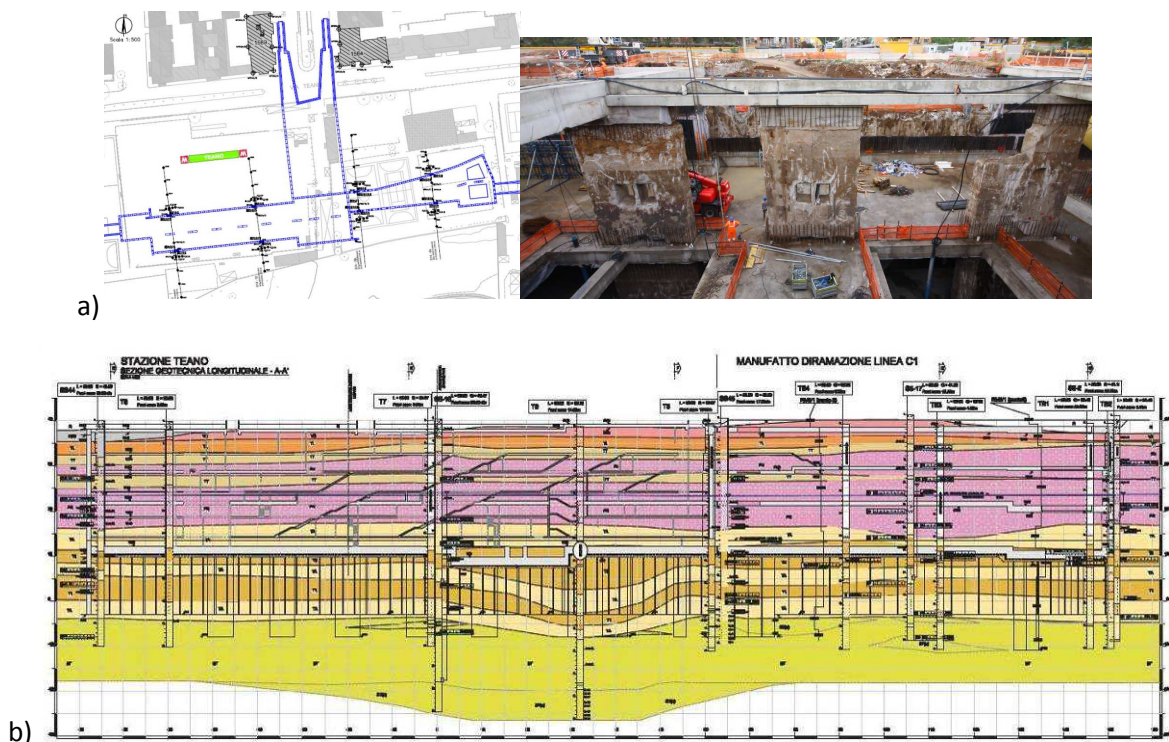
Stazione Teano: a) Planimetria e veduta di insieme b) Sezione geotecnica longitudinale
